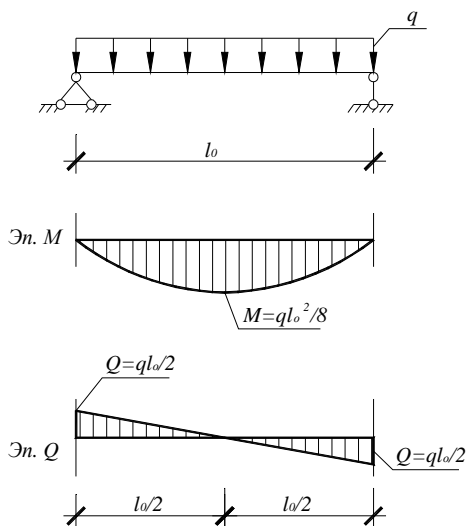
Расчетная схема плиты, эпюры усилий.
